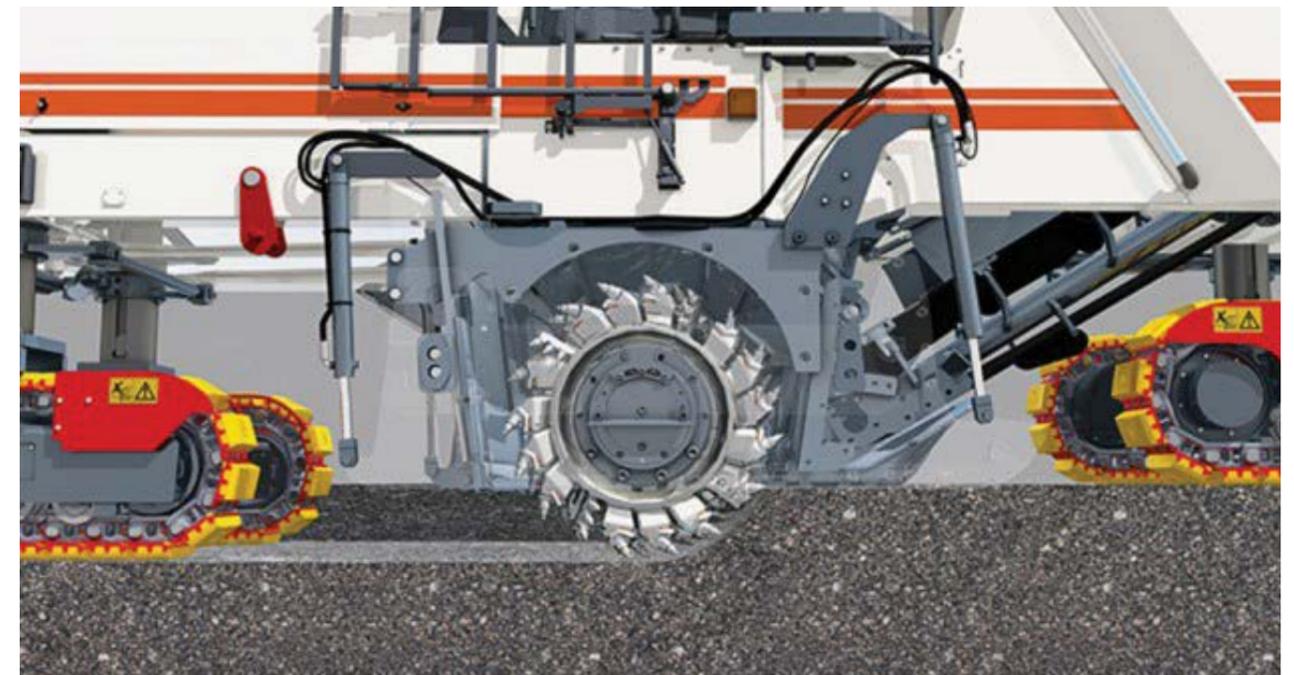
Kaltfräse der Firma Wirtgen® mit klassischer Frästechnik
